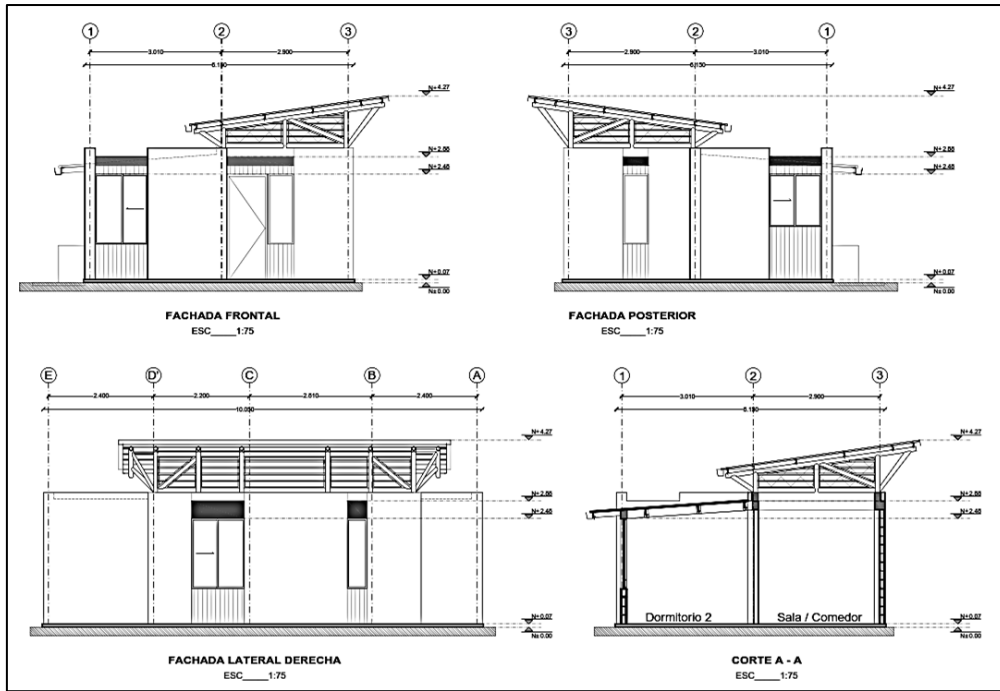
Elevaciones/Fachadas de vivienda hormigón armado Fuente: (MIDUVI, 2023)
